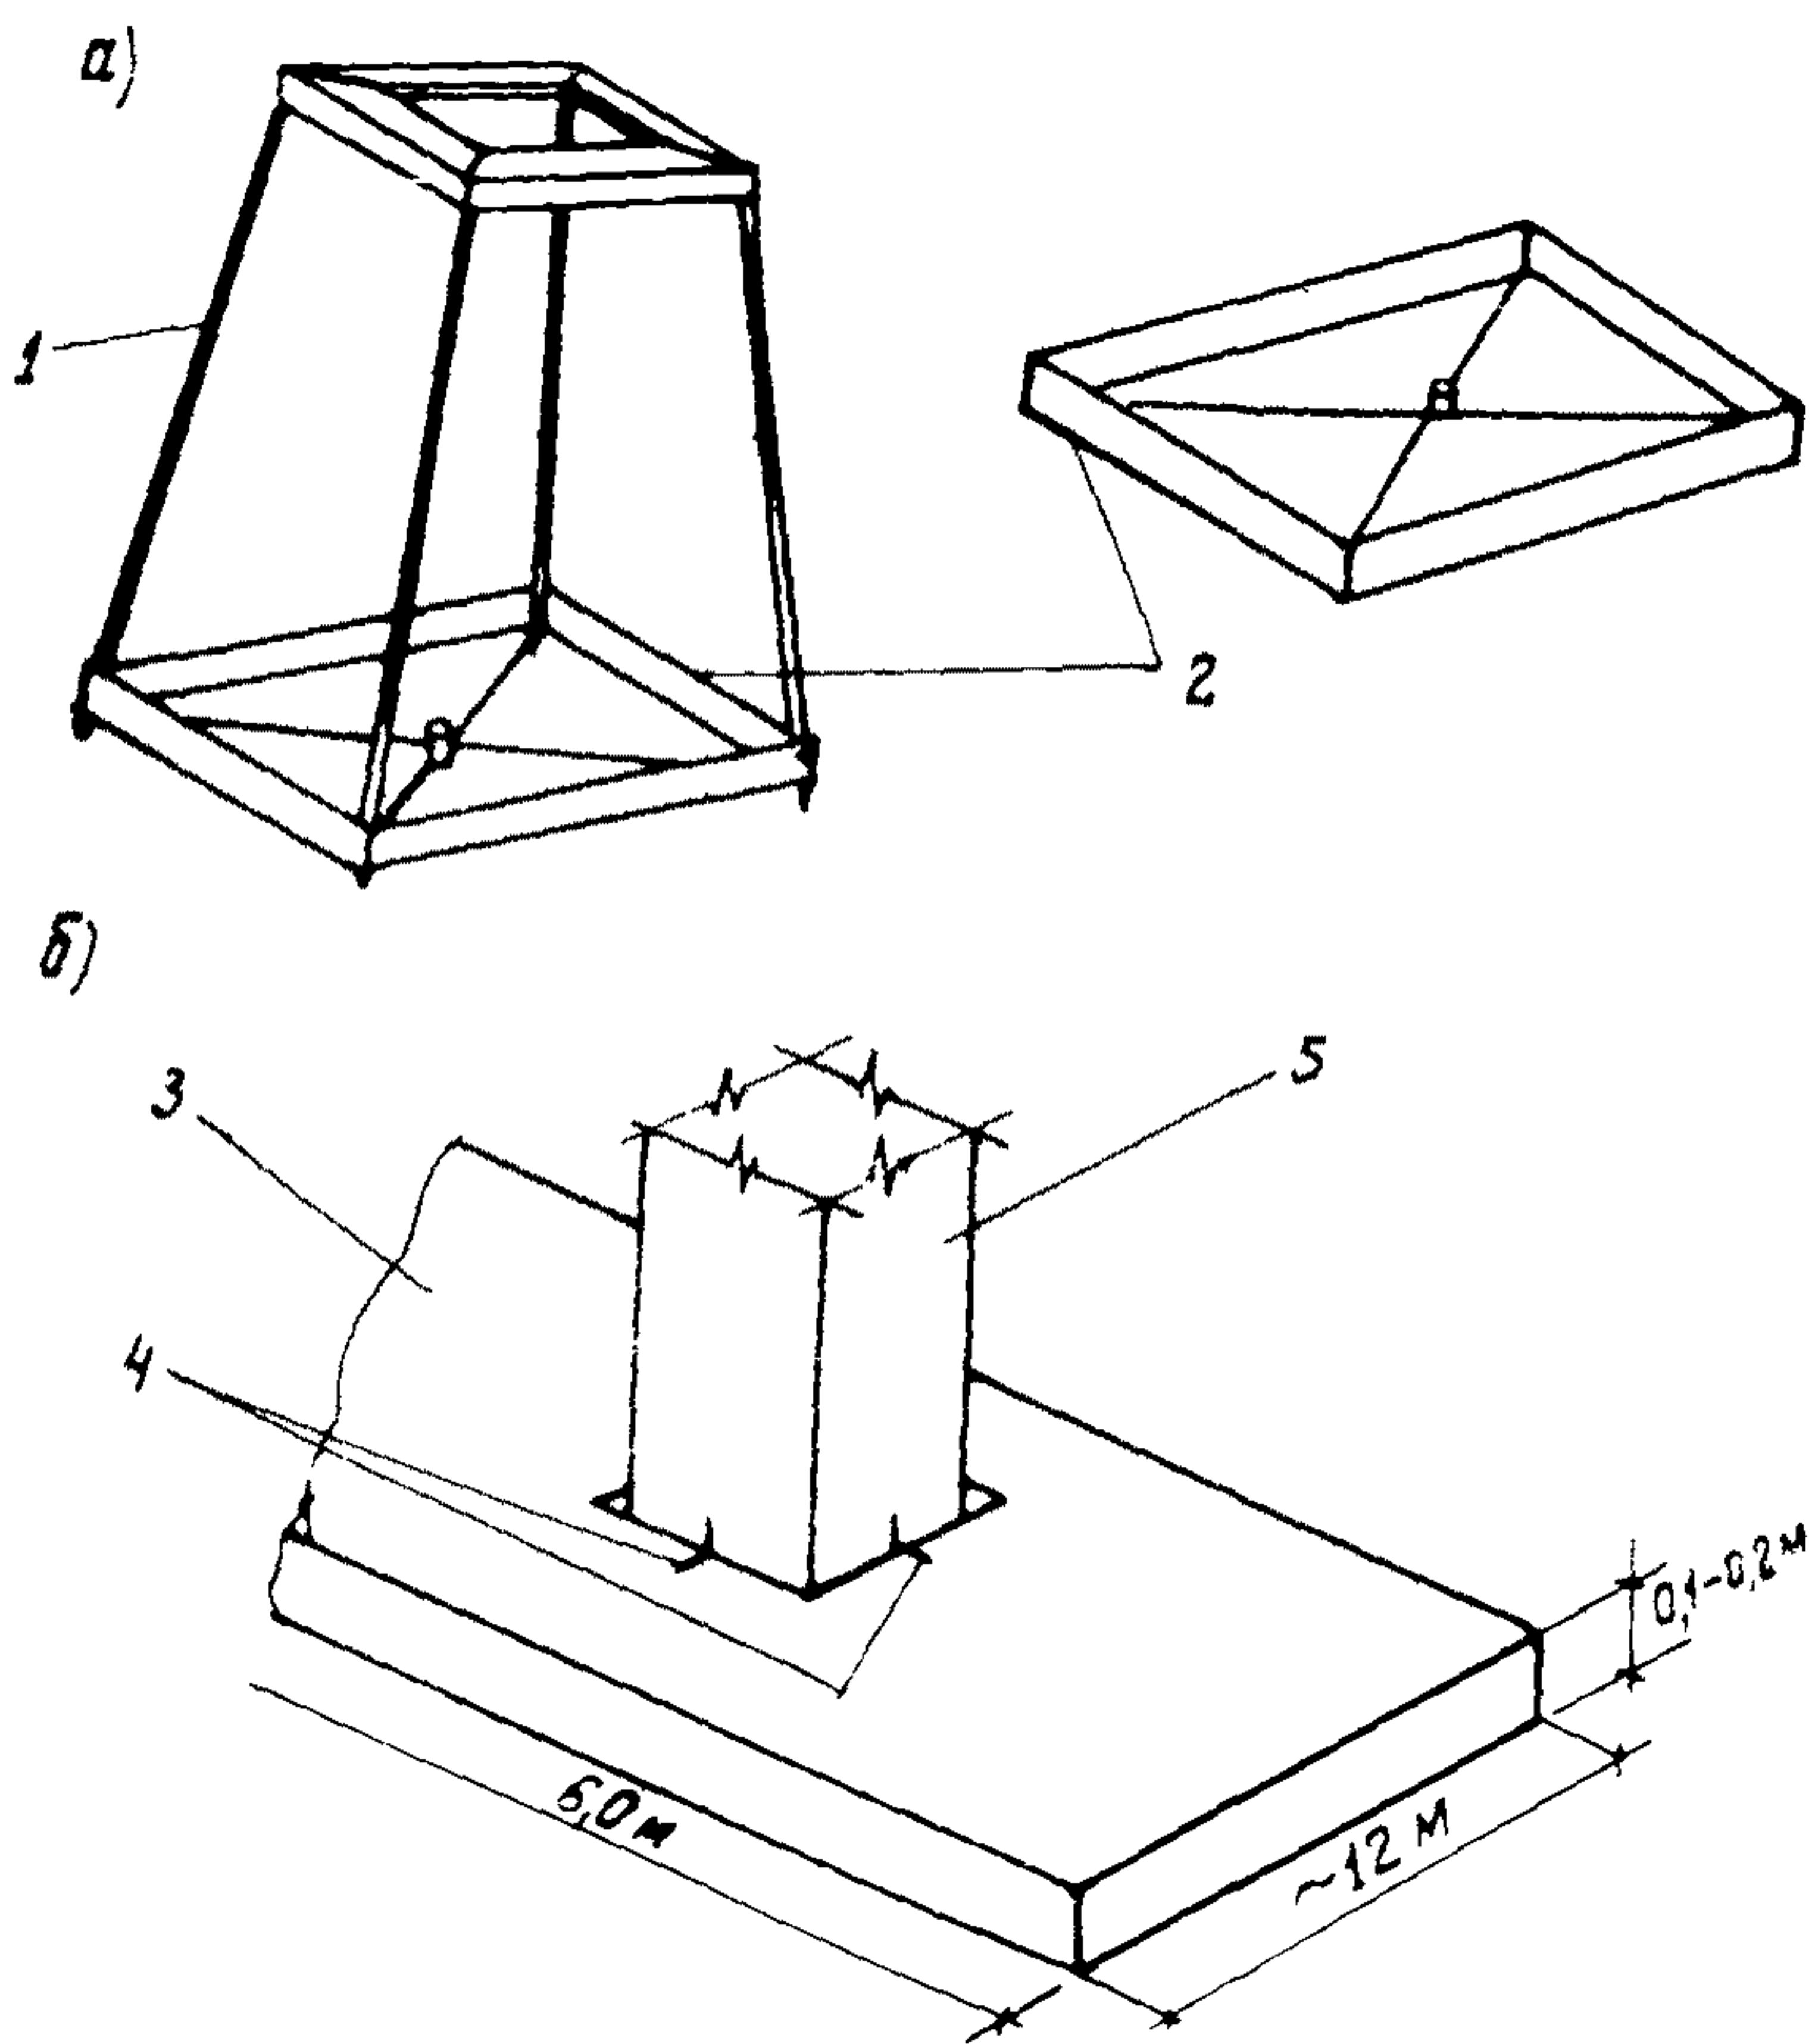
Кондукторы для обеспечения точности установки свай перед забивкой:
